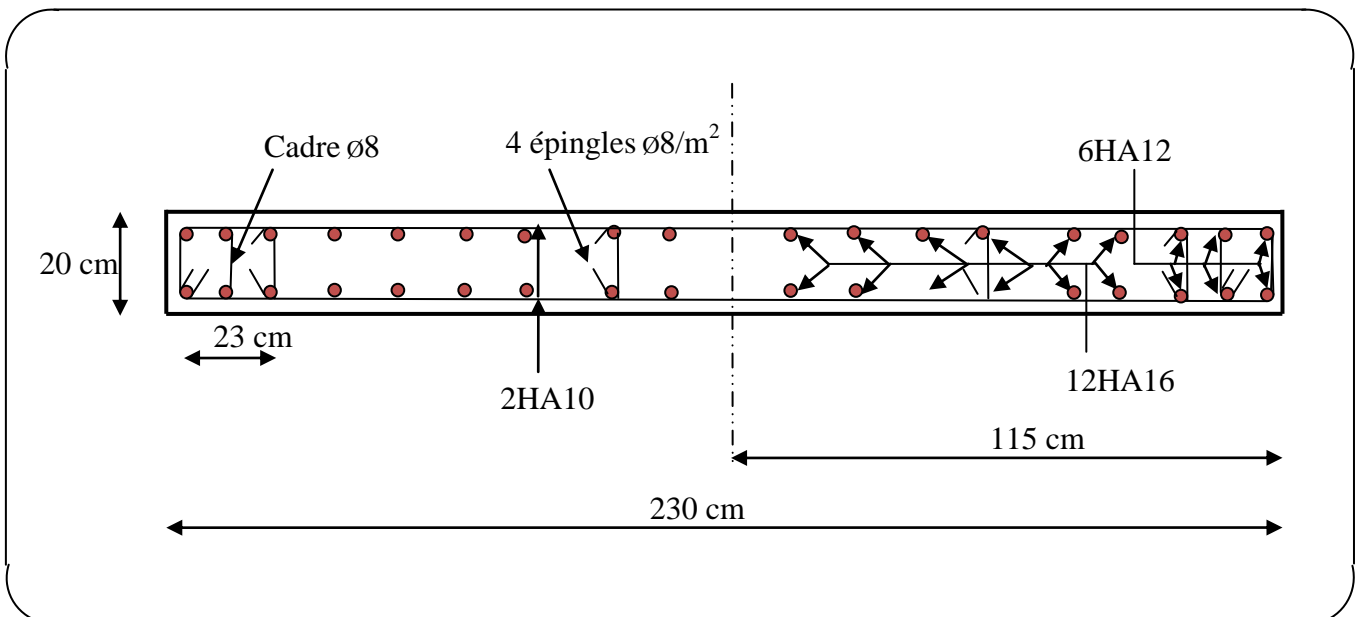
Schéma de ferrailage du voile Vx1 au niveau du RDC
